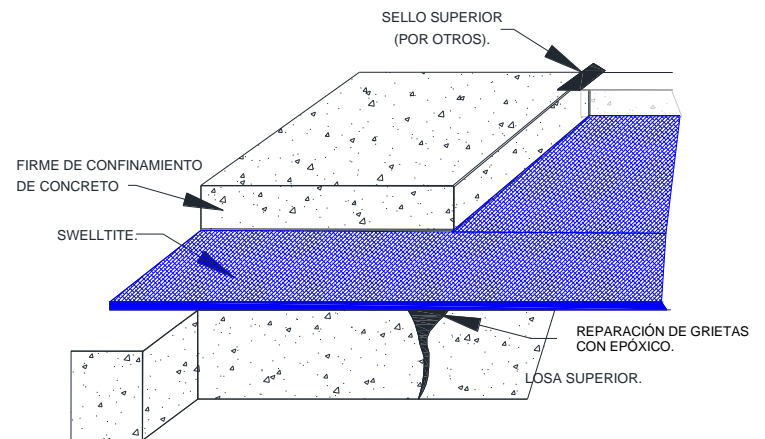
Corte del sistema de impermeabilización y drenaje.
